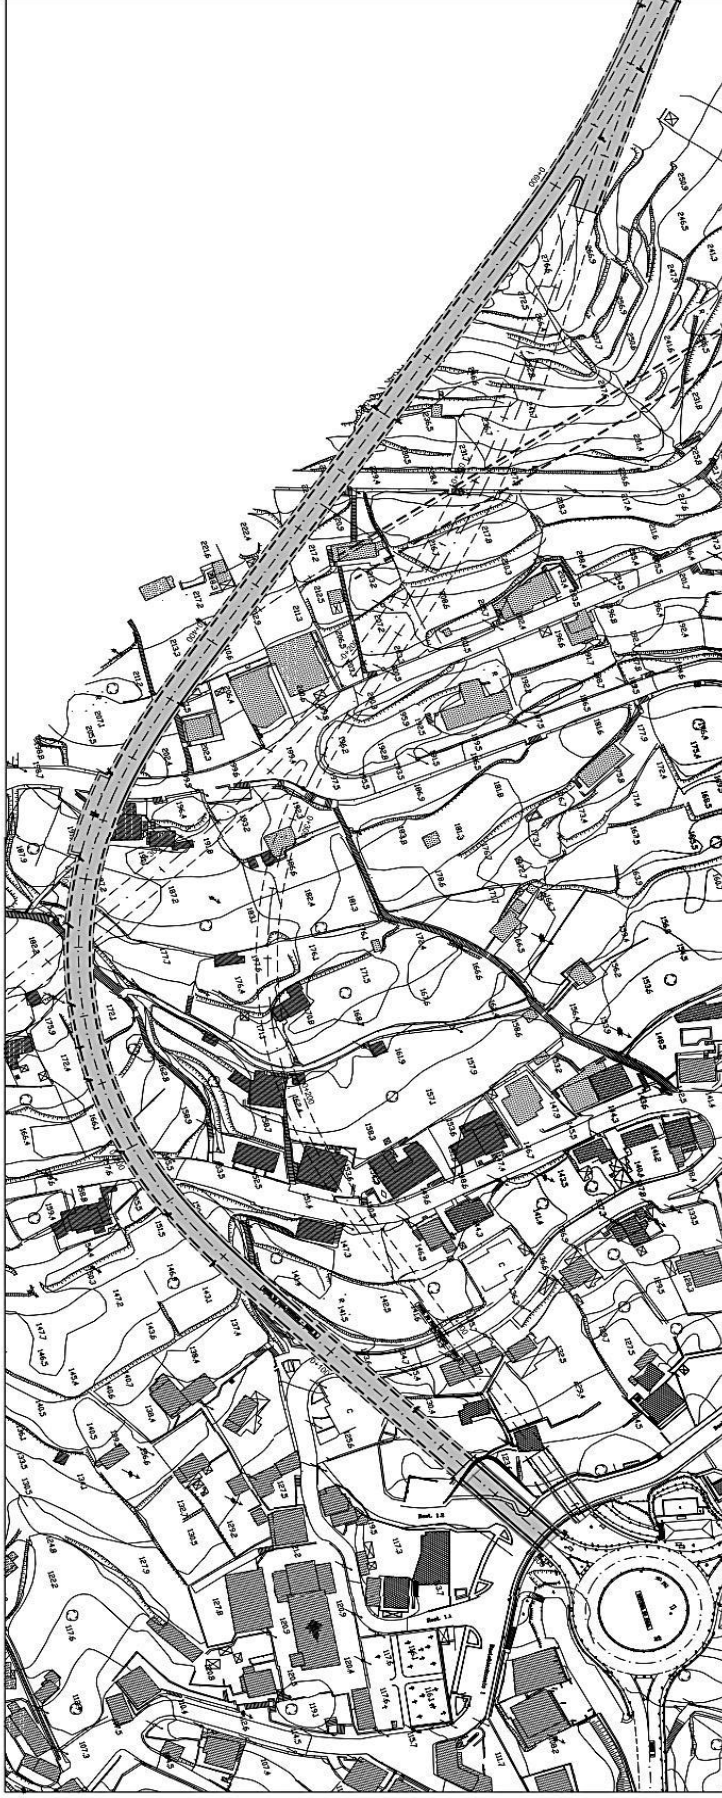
Planta do Túnel do Cortado com secções instrumentadas (Horgan, 2004)
